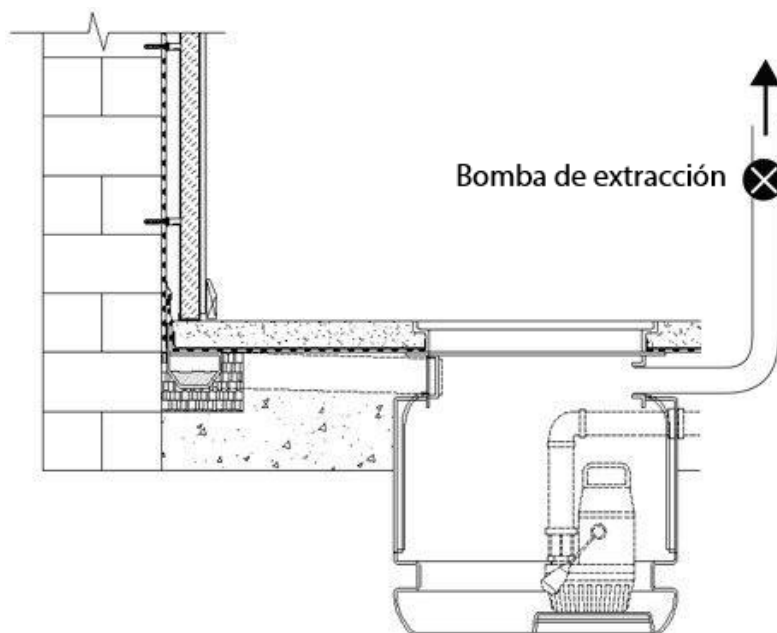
Detalle constructivo de instalación de sistema de despresurización por pozo de extracción con tiro forzado.
